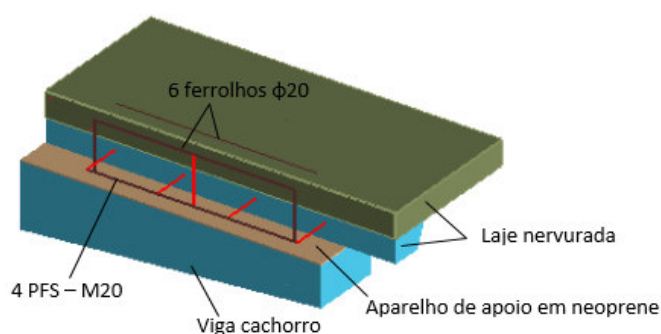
Modelação da ligação entre rampas e viga cachorro.
